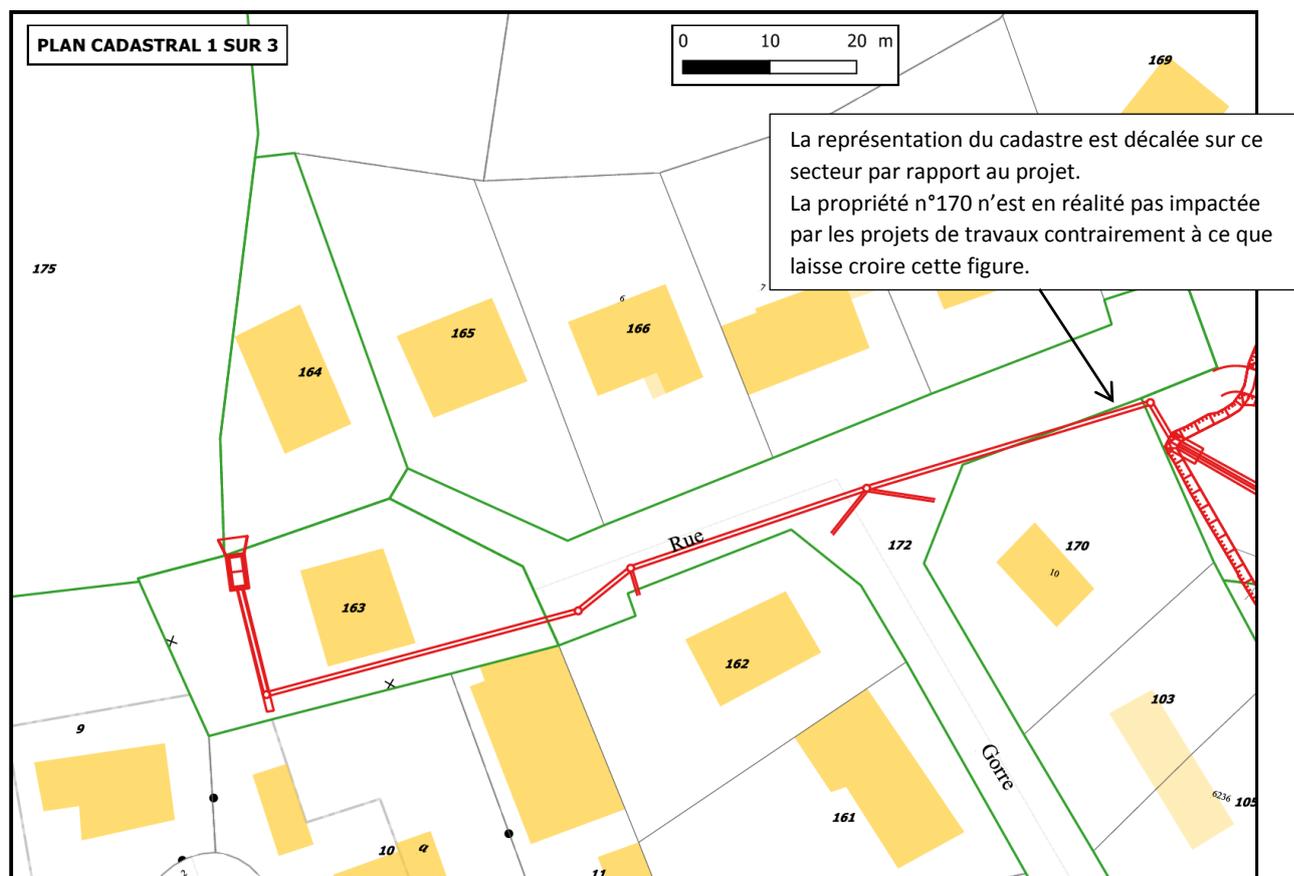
Extrait de l'annexe 3 : plan cadastral 1 sur 3
